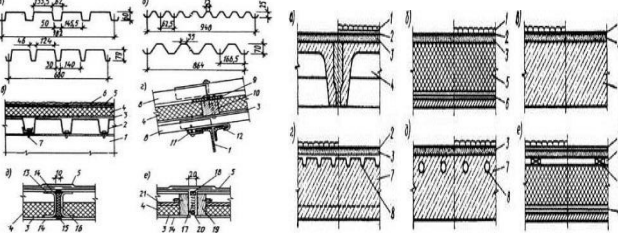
Конструкция перекрытия со столбами колонн, несущими настилы, используемая в качестве балки (перекрытие Робертсон)
